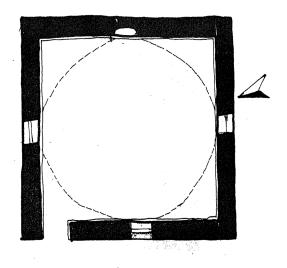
الجامع القديم – الشهابية – مسقط أفقى
